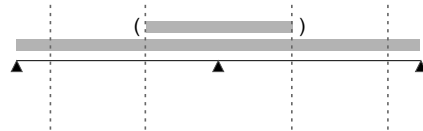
Typisierte Bewehrungsanteile der Biegebewehrung am oberen Querschnittsrand am Beispiel eines Zweifeldträgers
